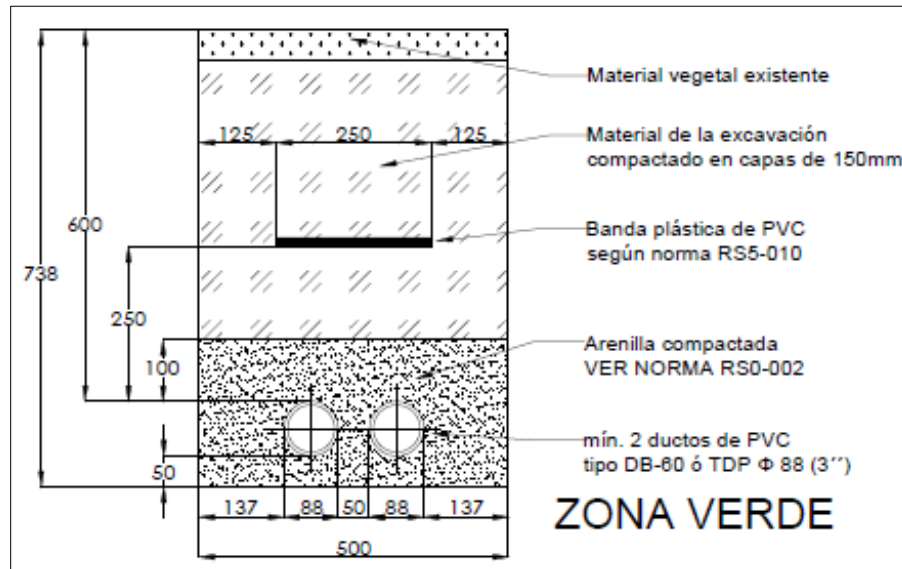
Detalle de la canalización de baja tensión zona verde
